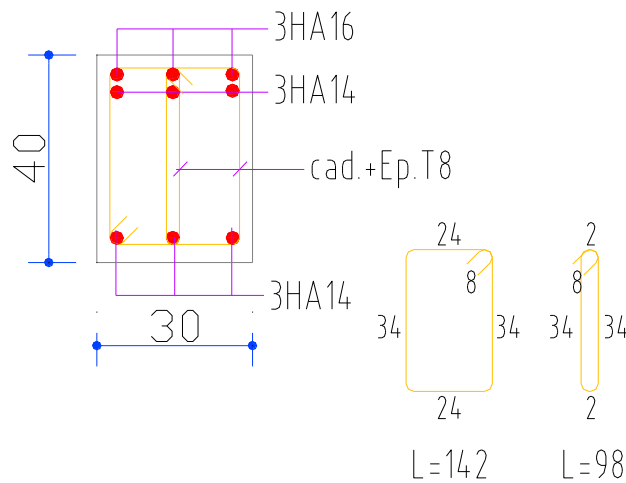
Ferrailage des poutres principales au niveau d'appui.
